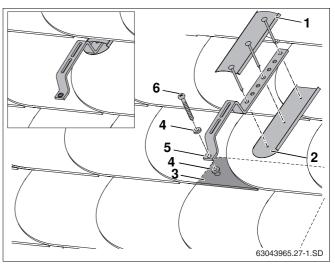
Montage sur les toits de bardeaux / d'ardoises
